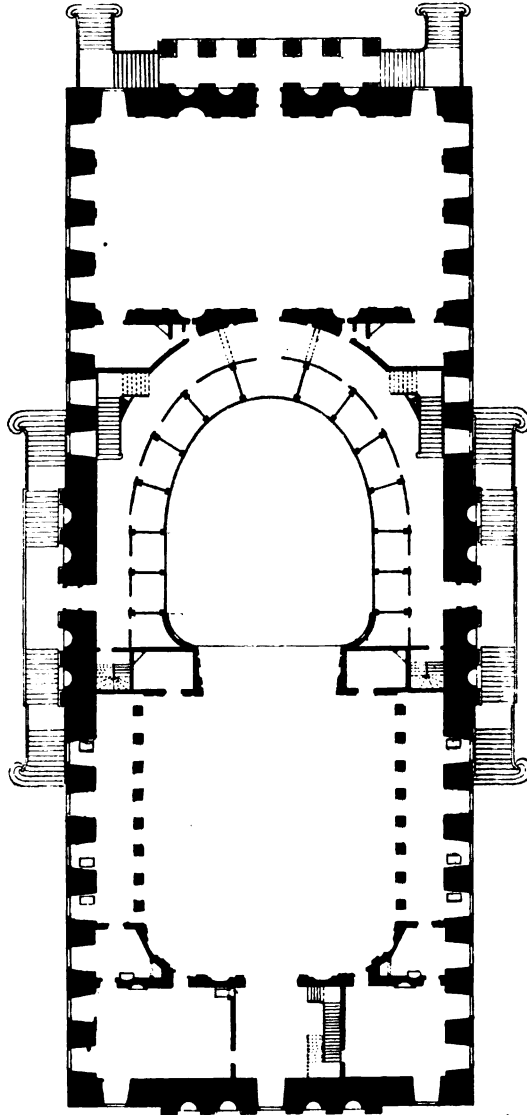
Grundriss des Opernhauses in Berlin (n. Fünck).
